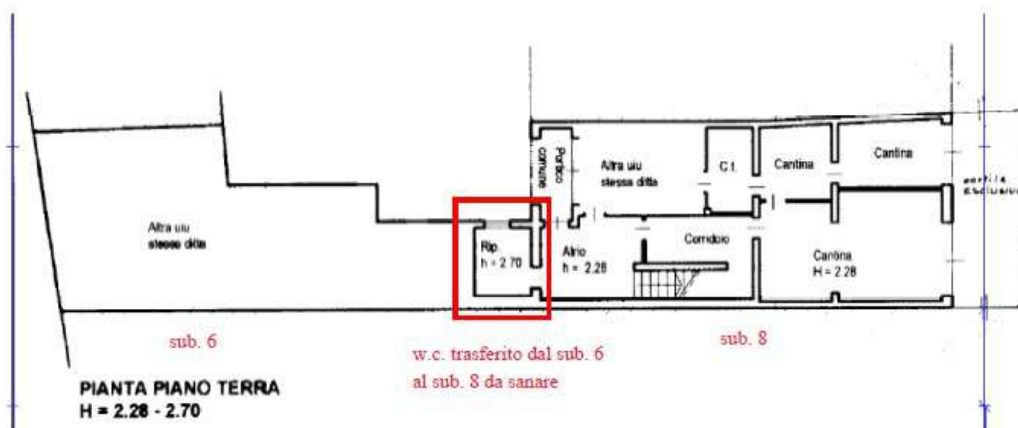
Planimetria p.lla 463 sub. 8 con evidenziato il locale w.c.
